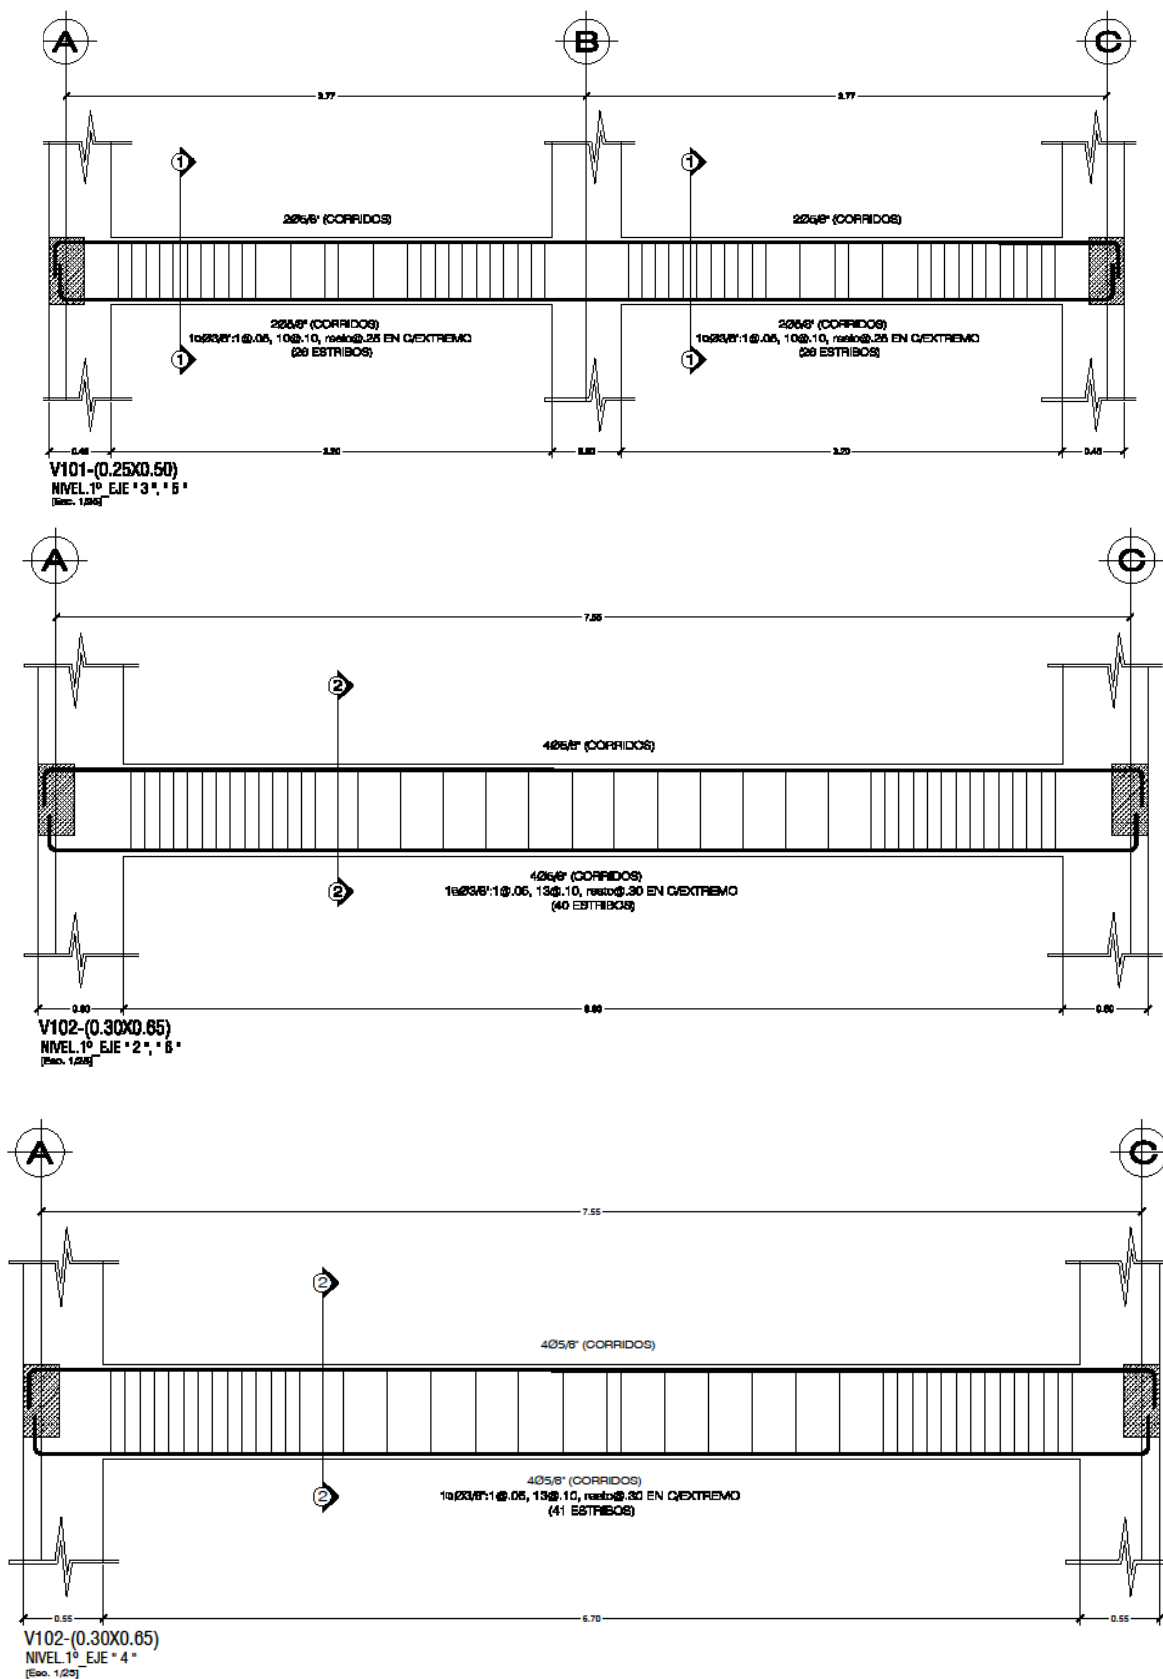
Armado de Vigas Preliminar para el Análisis Estático No lineal-Pushover en el Software Etabs V.16.2.1
